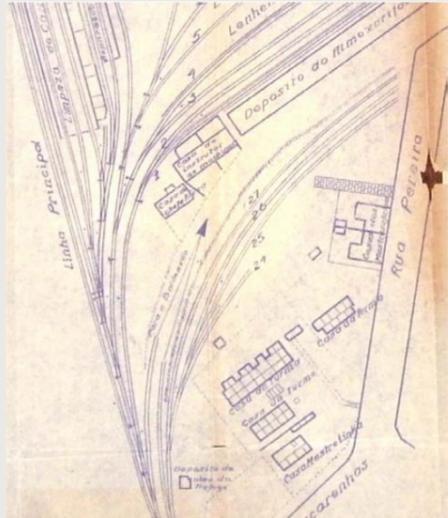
Implantação da Vila Riza. Fonte: CONDEPACC. s/d. Retirado de BERTUCCELLI ET AL., 2008.
